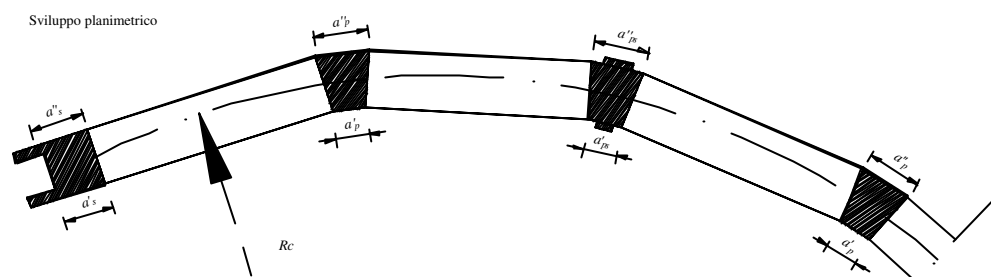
Tracciato planimetrico di un ponte/viadotto interamente in curva.
